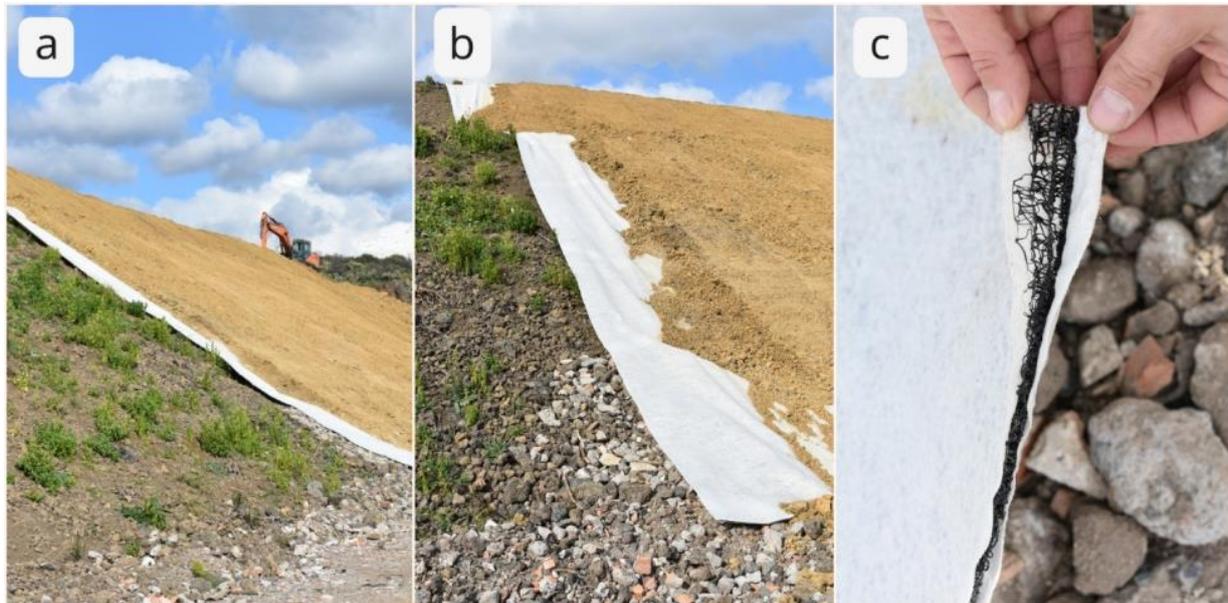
a - Intervento di posa geotessile a terreno nell'area di cava; b - Geotessile di separazione e terreno sovrapposto; c - Ordito del geotessile
